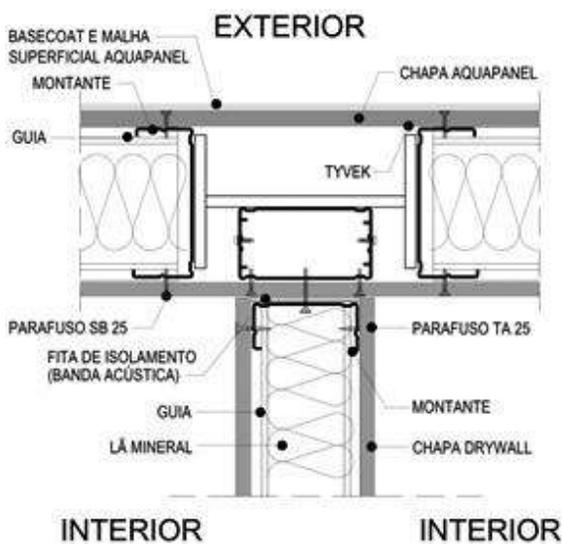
Detalhe em planta do encontro da vedação externa em LSF e interna em dry wall com um pilar metálico da estrutura principal do edifício. (KNAUF, 2009)
